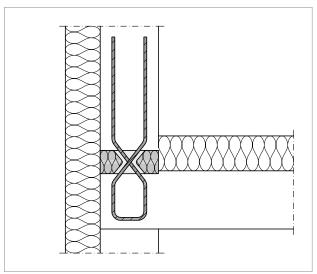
Schöck Sconnex® type W-N-VH : mur extérieur ; isolation sur la dalle selon la coupe C-C
